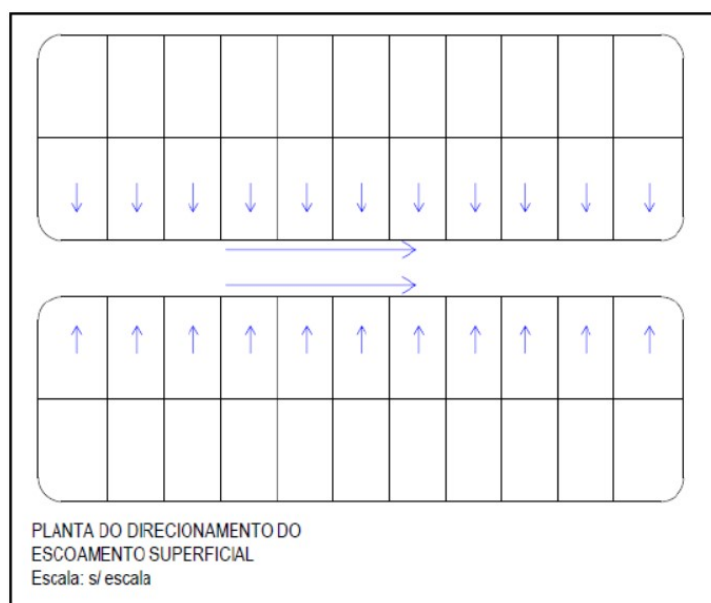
Planta Esquemática do Escoamento Superficial do Loteamento.
